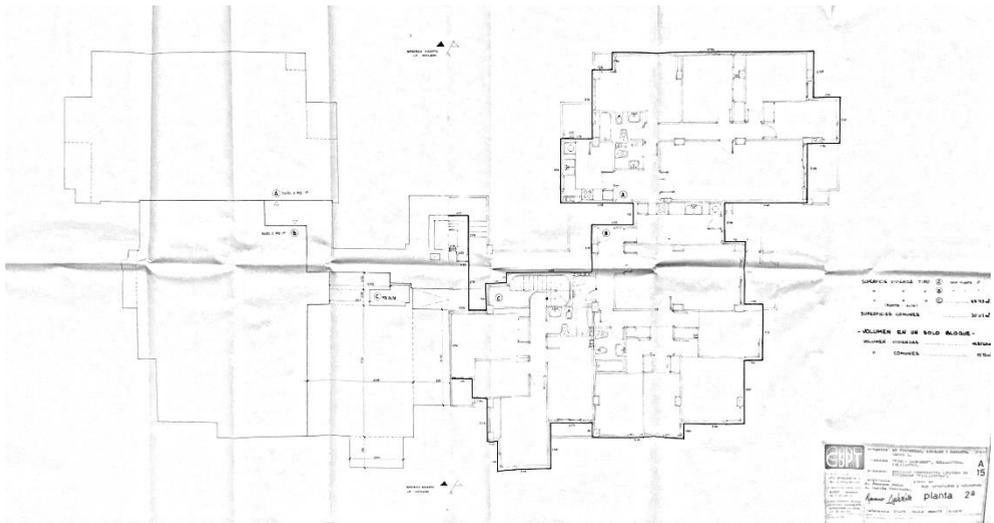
Plano de planta segunda del proyecto cooperativa Villajoyosa. Fuente: Archivo personal de CSPT.
